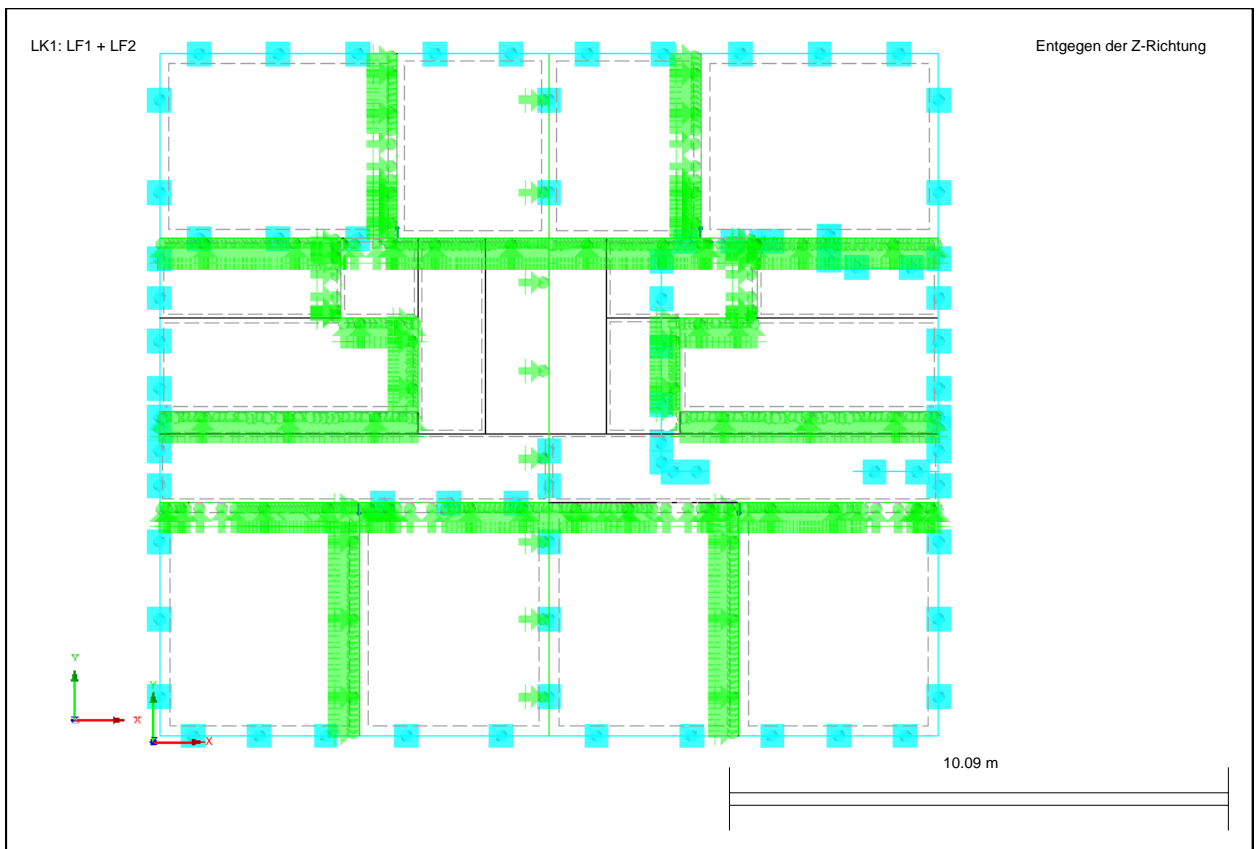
Grundrissdarstellung (Ansicht in Z-Richtung)
